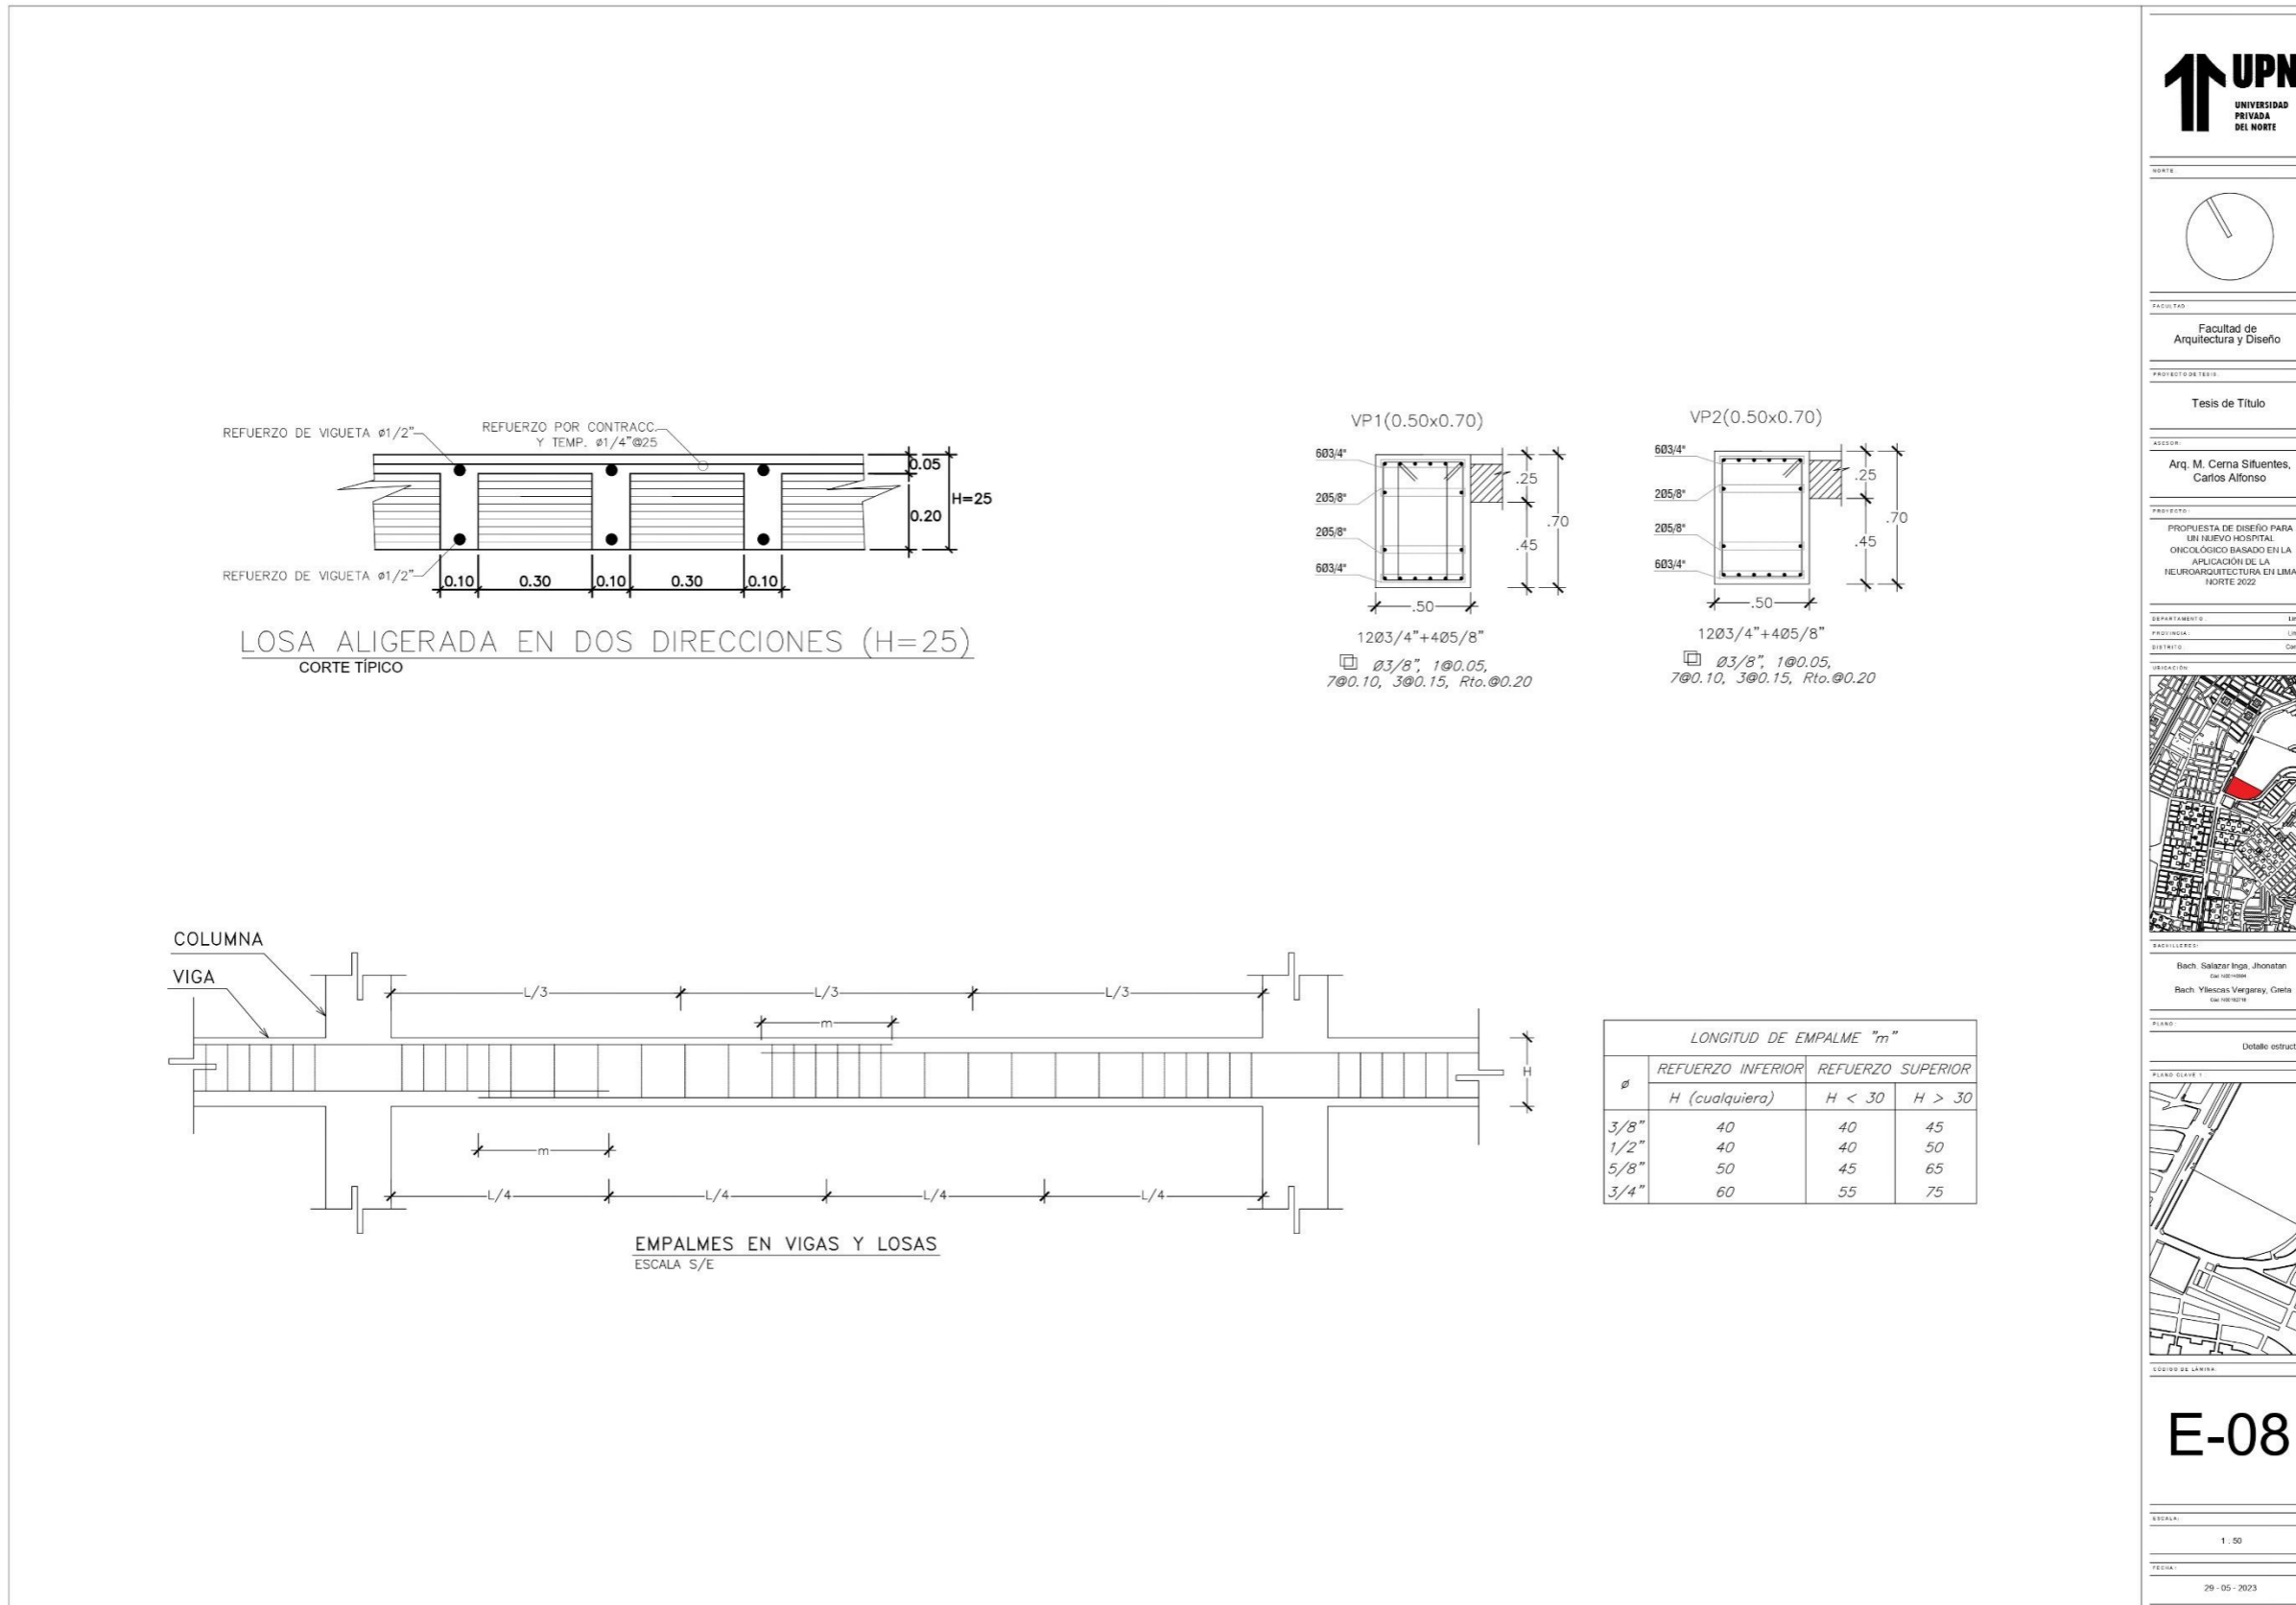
Estructuras – Detalle del sector cuadrante N° 1 Esc: 1/75 (Fuente: Elaboración propia de los coautores)
